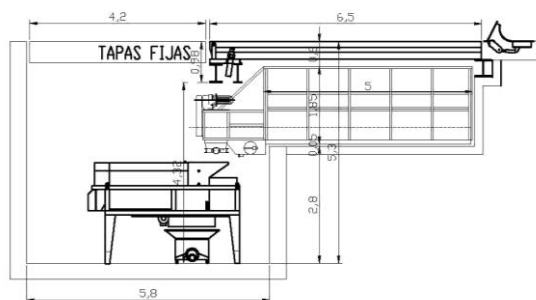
Plano de sección de implantación de despalladora-estrujadora alimentada desde tolva por gravedad.
